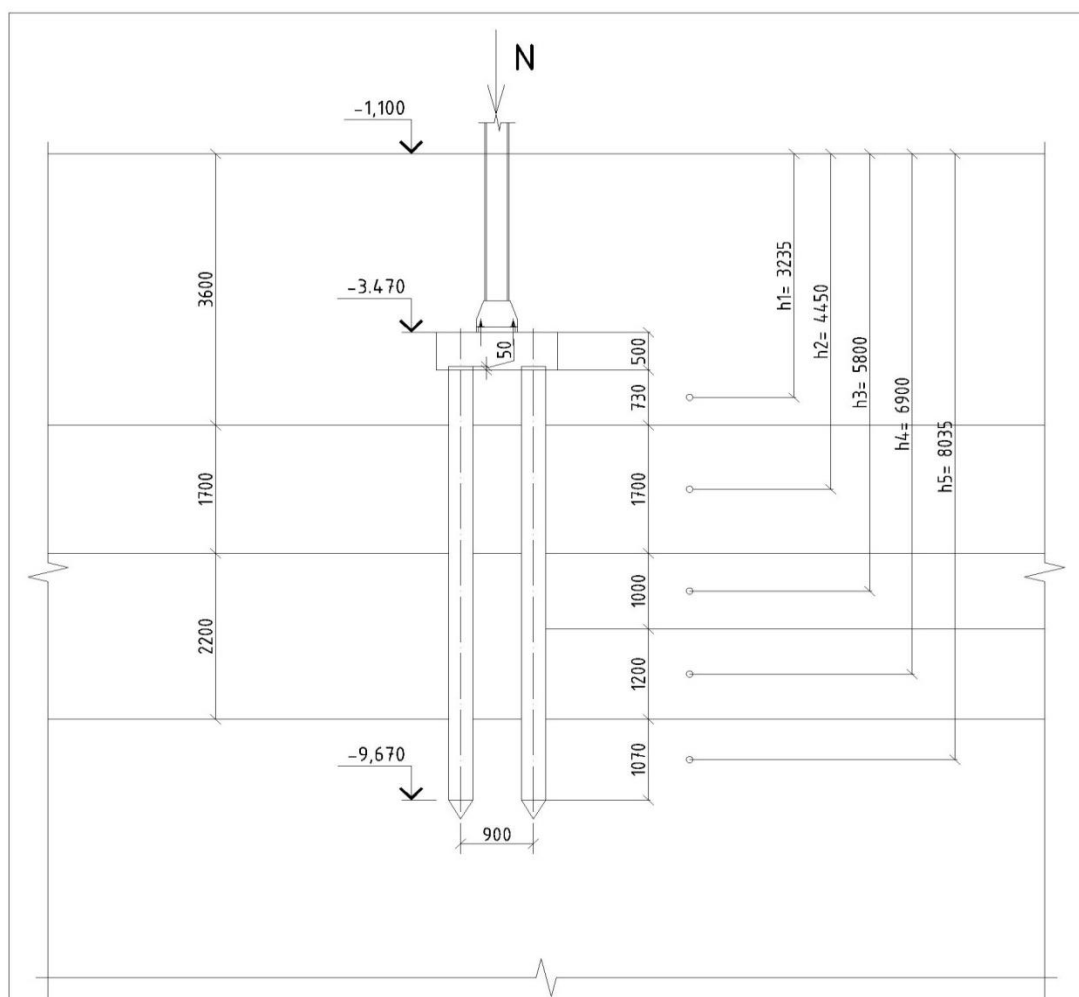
Посадка фундаментів на інженерно-геологічний розріз
